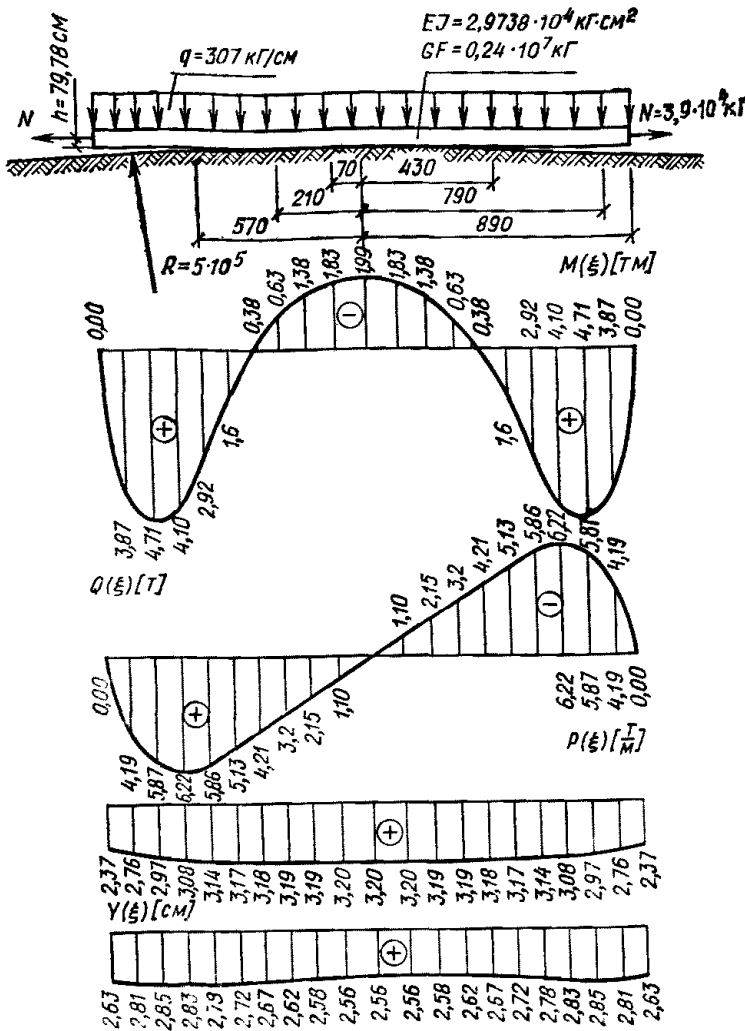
Расчетная схема здания и эпюры изгибающих моментов, поперечных сил, отпора грунта и прогиба здания
